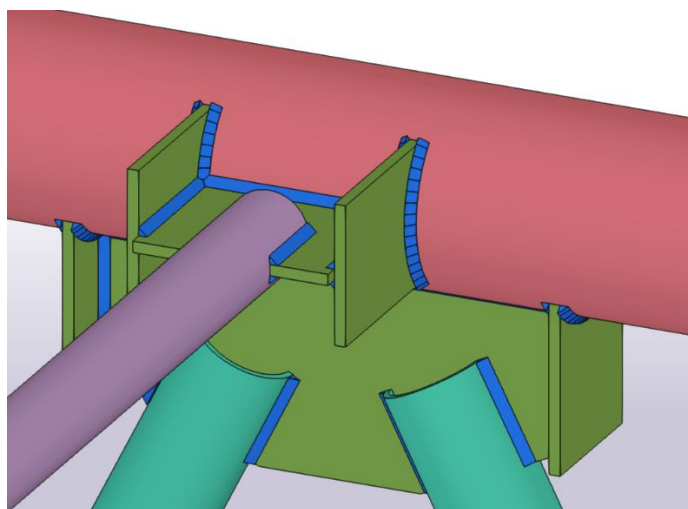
Вузол кріплення розкосів до верхнього поясу
